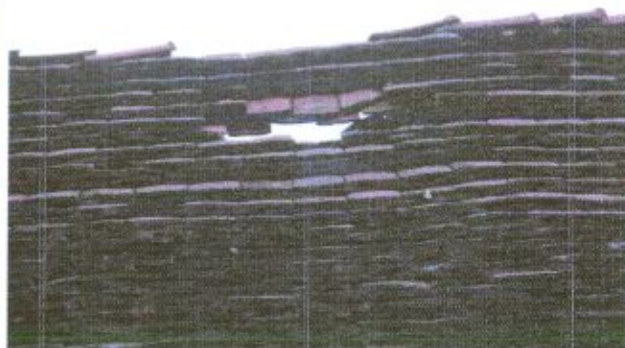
Od strony elewacji zachodniej widoczny jest zawalony dach. Ściany poniżej zawalonego dachu w bardzo złej kondycji. Cegły sypią się i pudrują, pozbawione są oryginalnego spieku. Gzyms jest uszkodzony. Pomiędzy ceglami brak spoiny, ponieważ została wypłukana.
